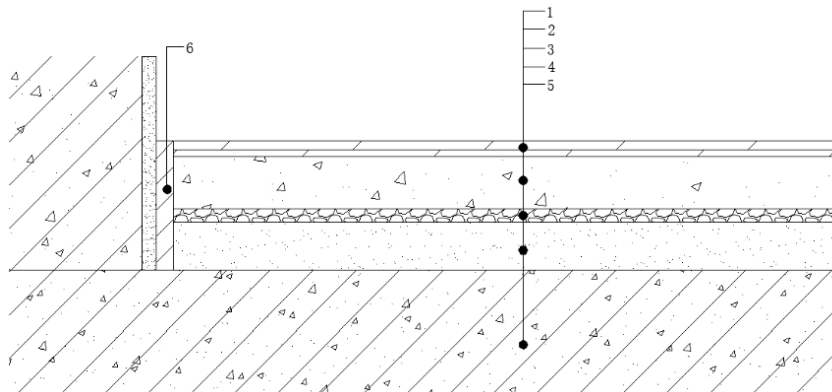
高抗裂混凝土保温隔声系统构造四
